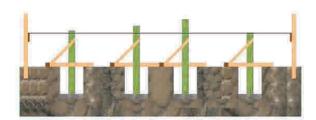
46: Control geométrico de los pilotes, planimetría y altimetría según plano. Arriostramiento de pilotes para cuidar la verticalidad durante el hormigonado del cimiento.
